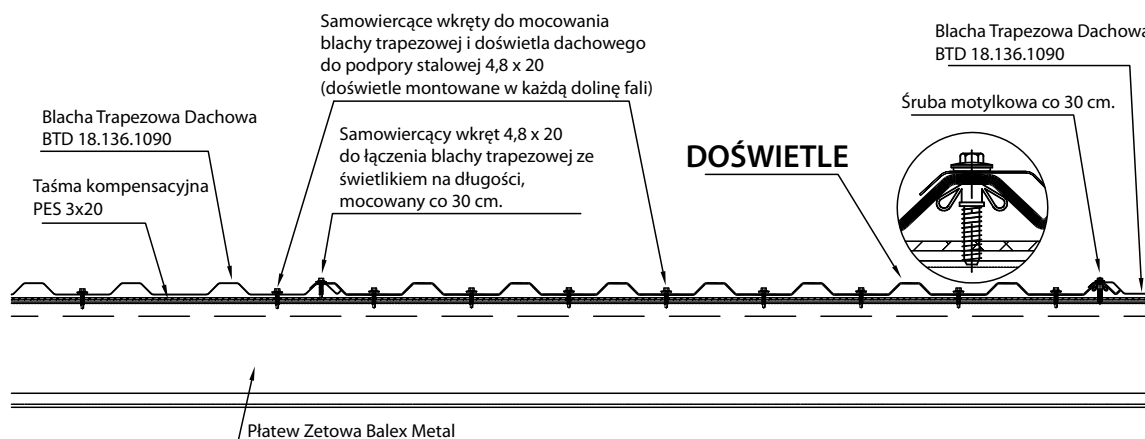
Sposób montażu doświetli dachowych na blachach trapezowych.
